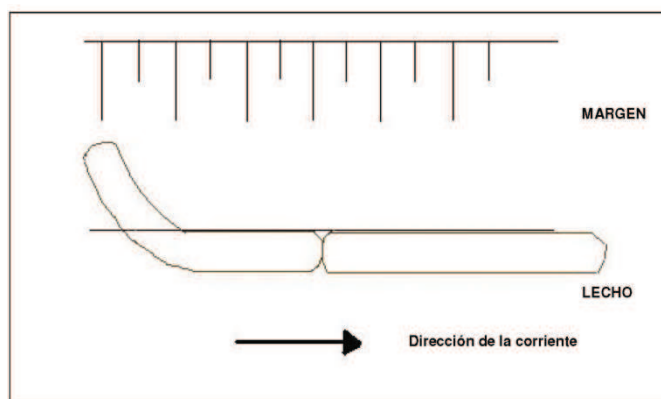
Encastado del primer Fiber rollTM al terreno (esquema en planta):
